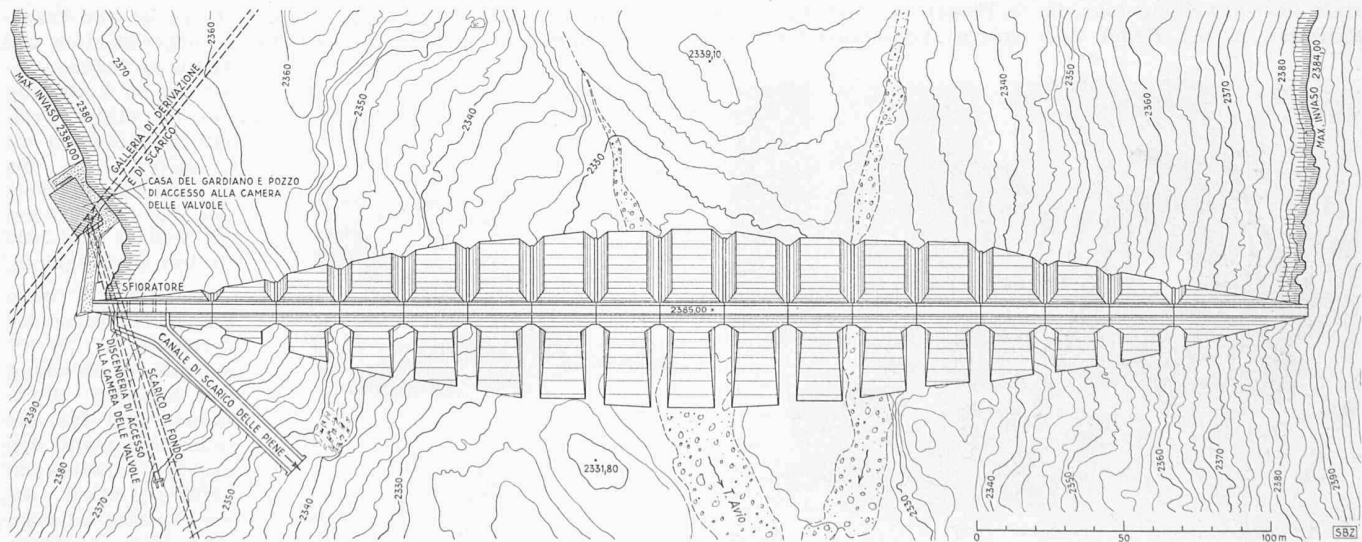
Pfeilerstaumauer für den Stausee Pantano d'Avio. Situation 1: 2500
